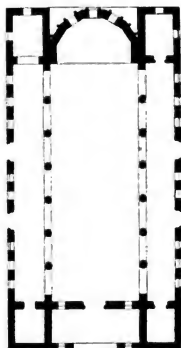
Basilika in Turmanin. Grundriss.
